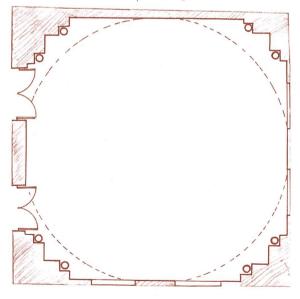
المسقط الأفقى لضريح الخراشي بدمنهور مقياس رسم ١ : ١٠٠
